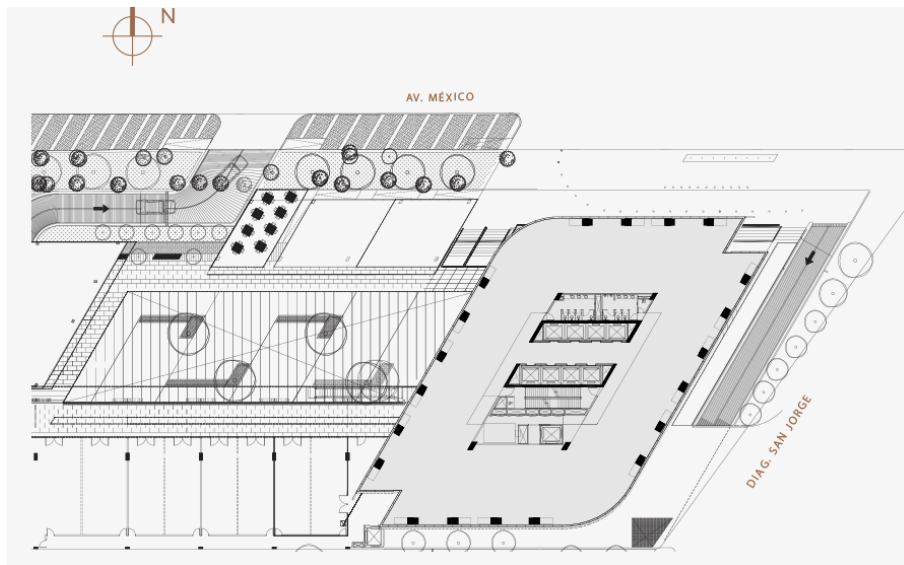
Planta arquitectónica tipo corporativo Central Park
